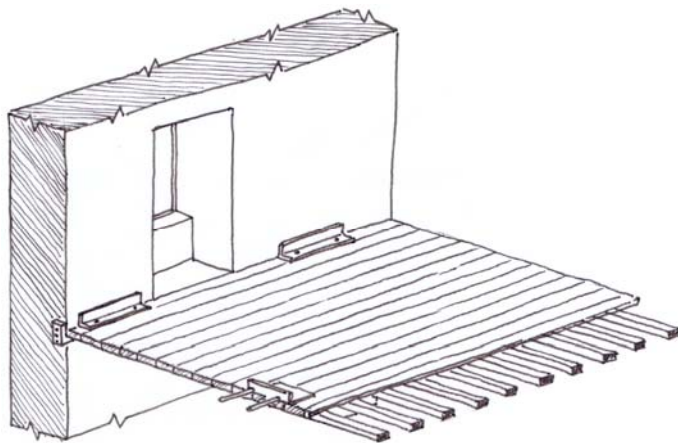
| Esquema da introdução de peças para solidarização da estrutura do pavimento (adaptado de [11])
